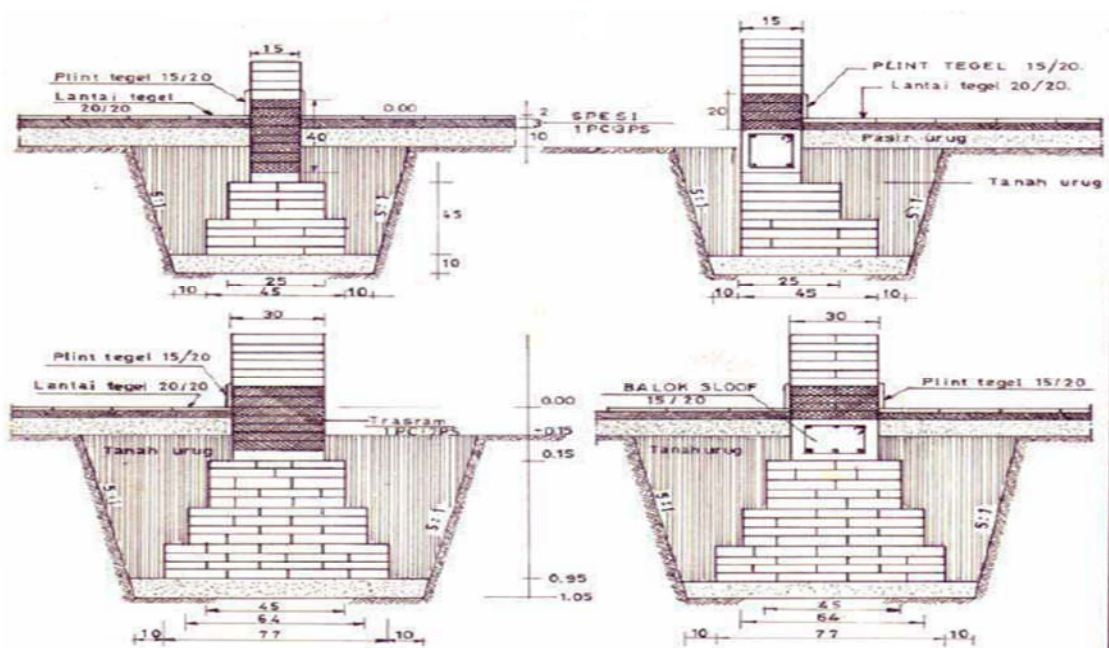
Pondasi memanjang Batu Kali
